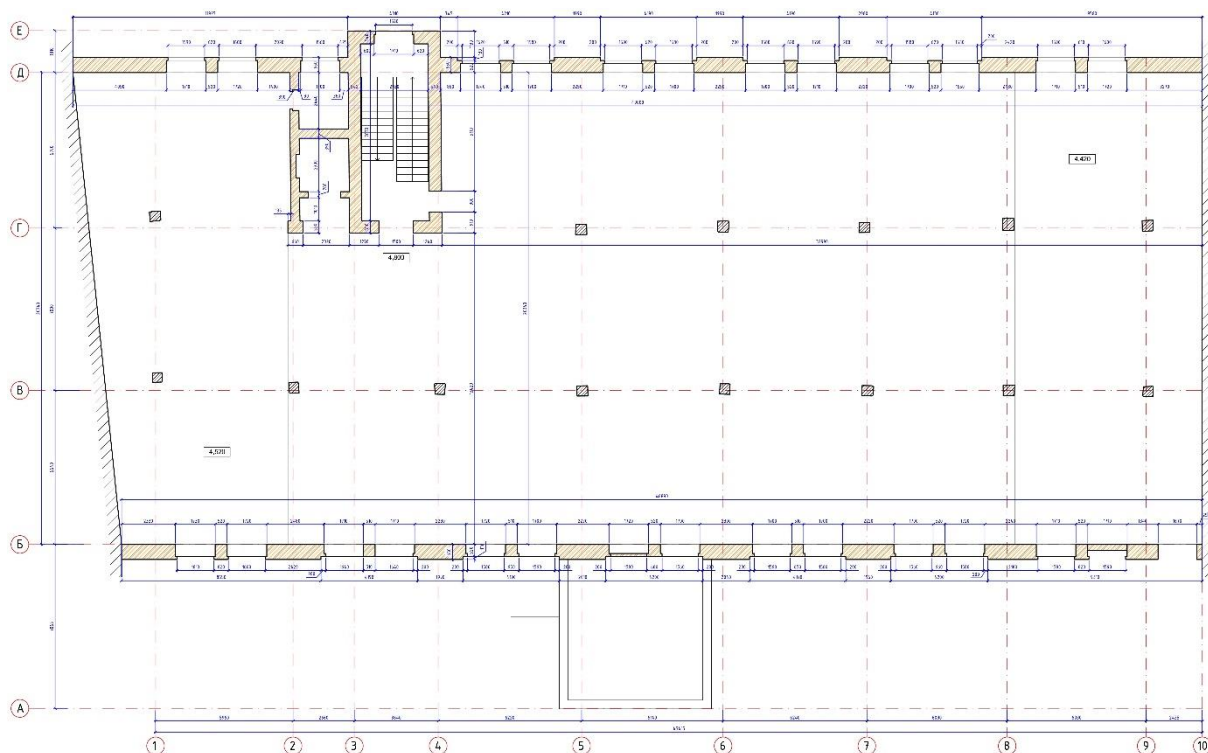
План 2-го поверху існуючої будівлі (на час дослідження)
